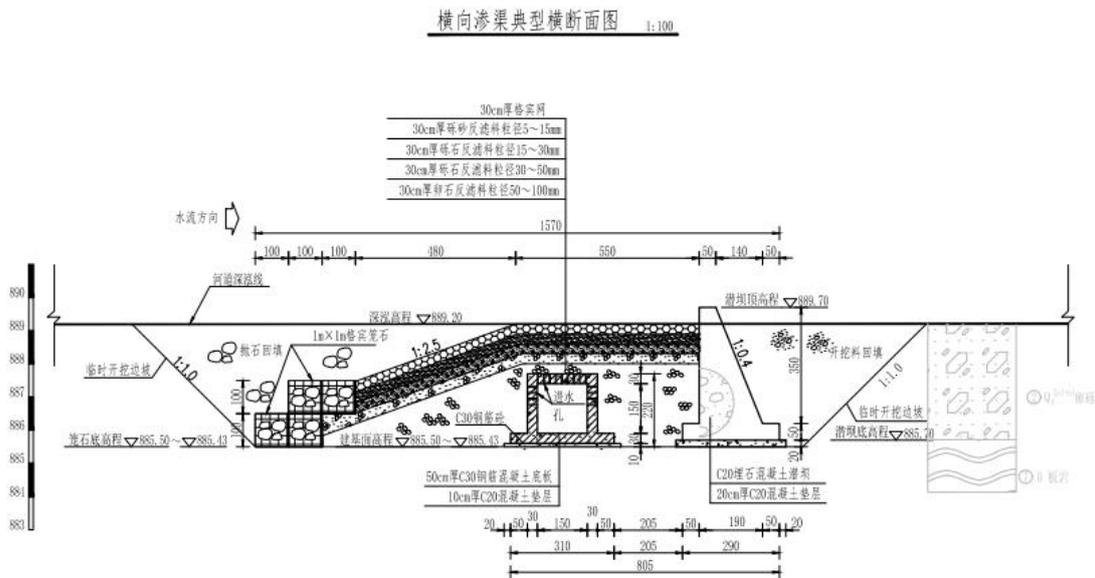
两岭水厂取水枢纽横向渗水廊道横断面图
